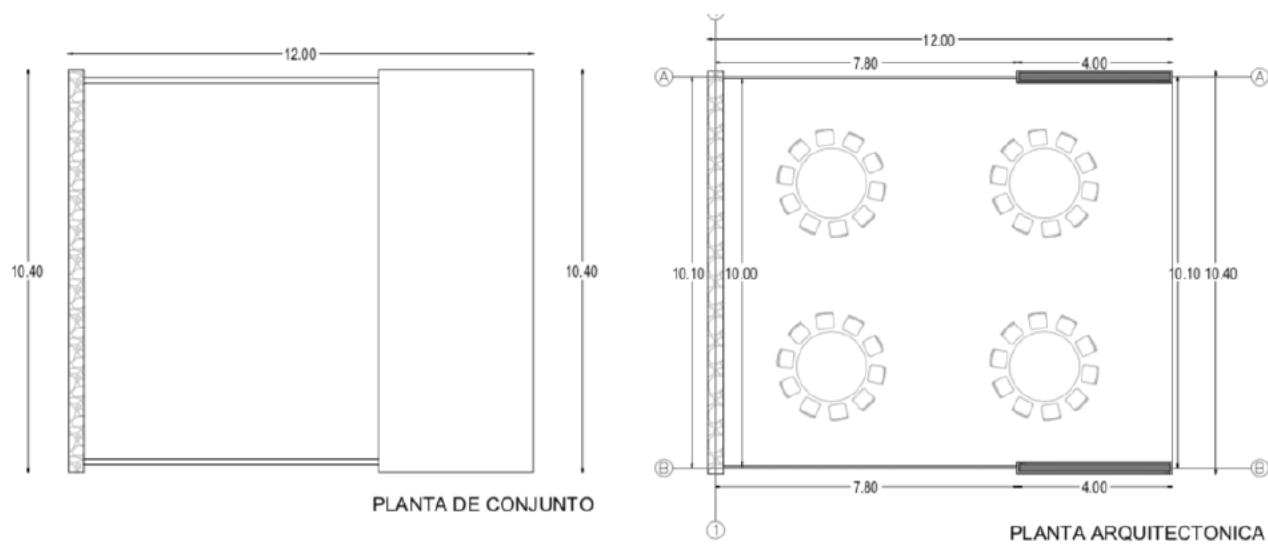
PLANTA DE CONJUNTO Y ARQUITECTONICA DE LA CASA CLUB
